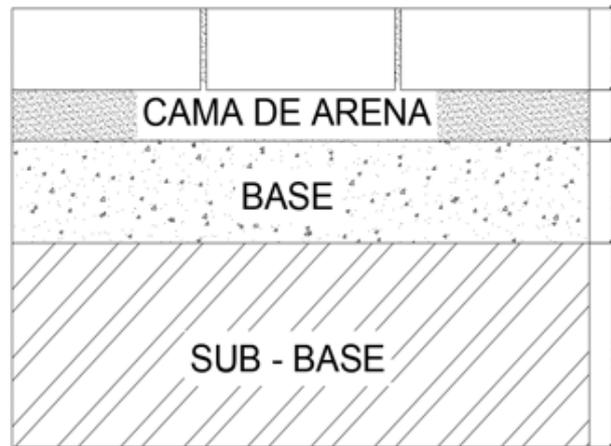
Esquema de corte del pavimento adoquinado diseñado
